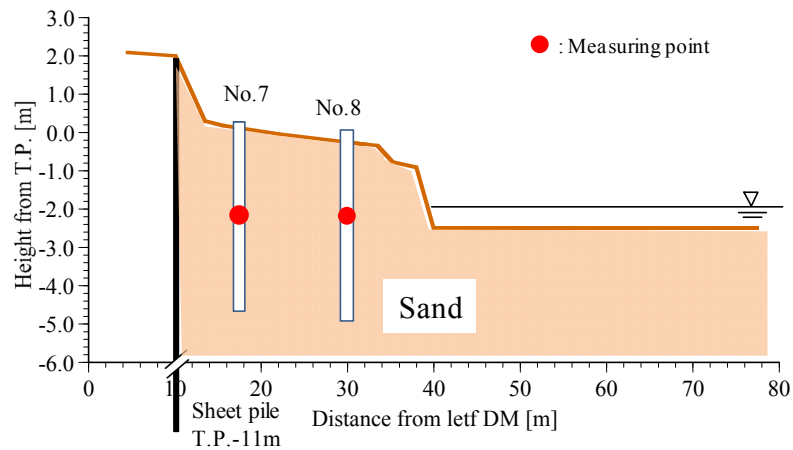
St.2-2 の横断面図と測定位置（機器は井戸内に設置されている）
